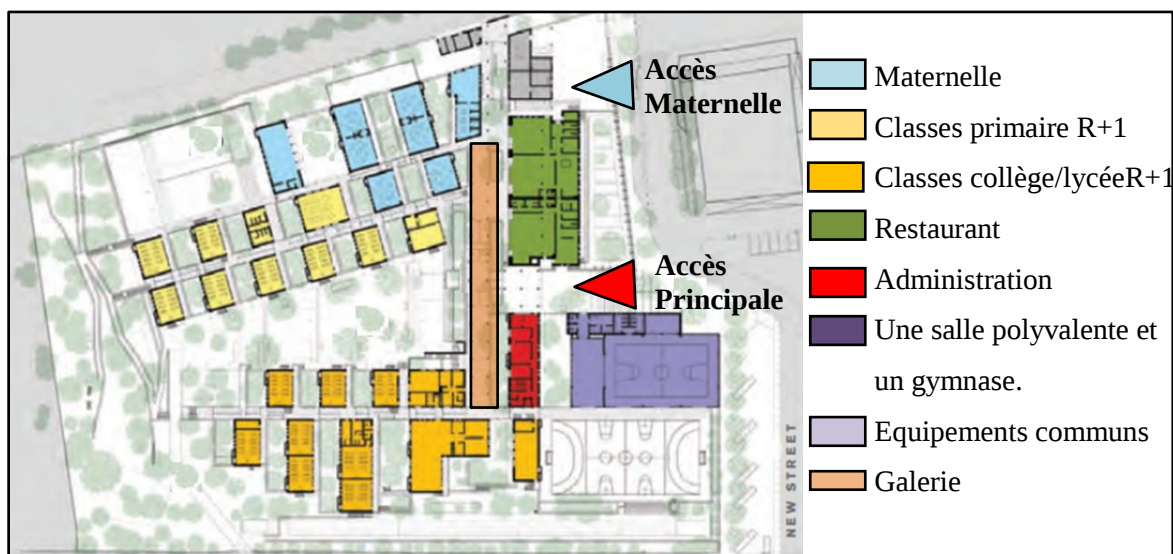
Plan rez-de-chaussée (Source : archnet.org)
